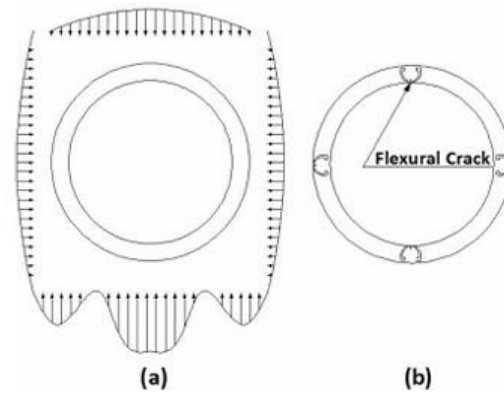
a) tensiones sobre tubos estructurales b) formación de fisuras en tubos estructurales (Peyvandi et al, 2014)
